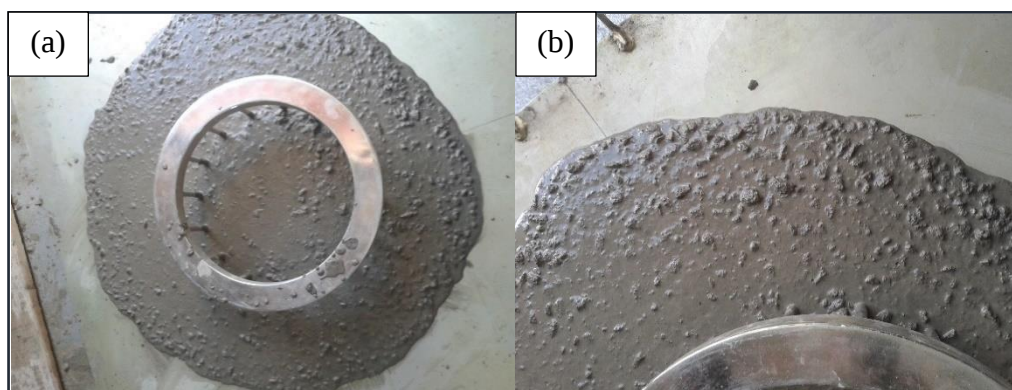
Ensaio de J-Ring para o CAA de referência. (a) Espalhamento do concreto, (b) Detalhe das bordas do espalhamento do concreto.
